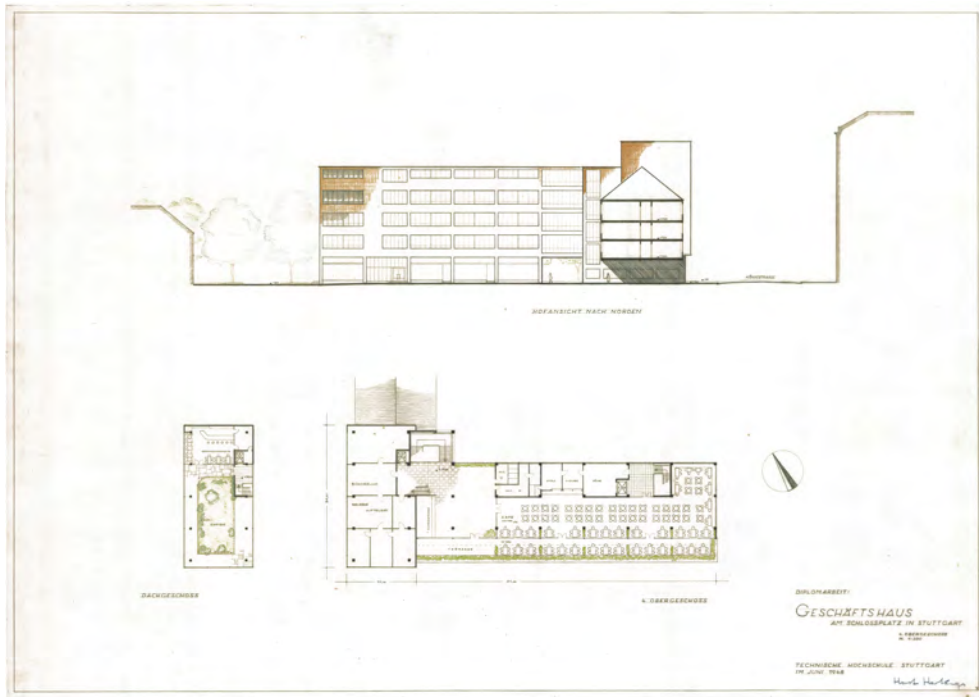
Diplomarbeit „Olgabau“, Hofansicht, 4. Obergeschoss, Dachgeschoss
